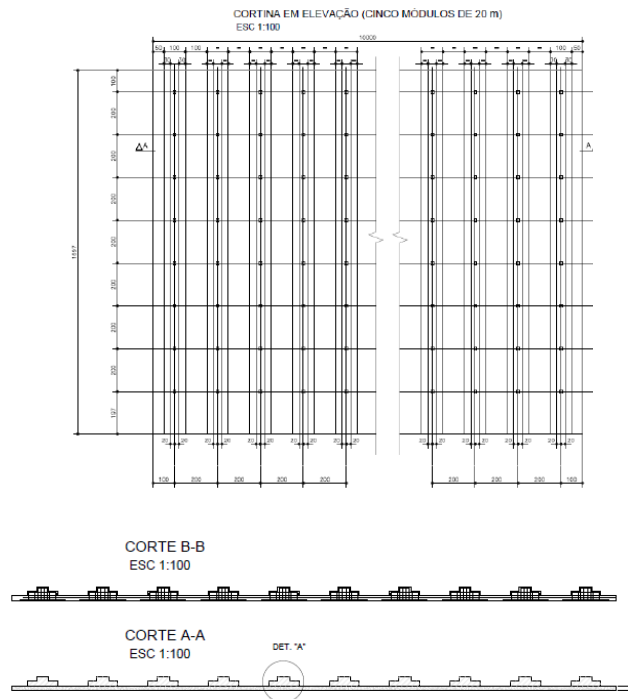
Talude 13 - Vista frontal da parede da cortina concreto.
